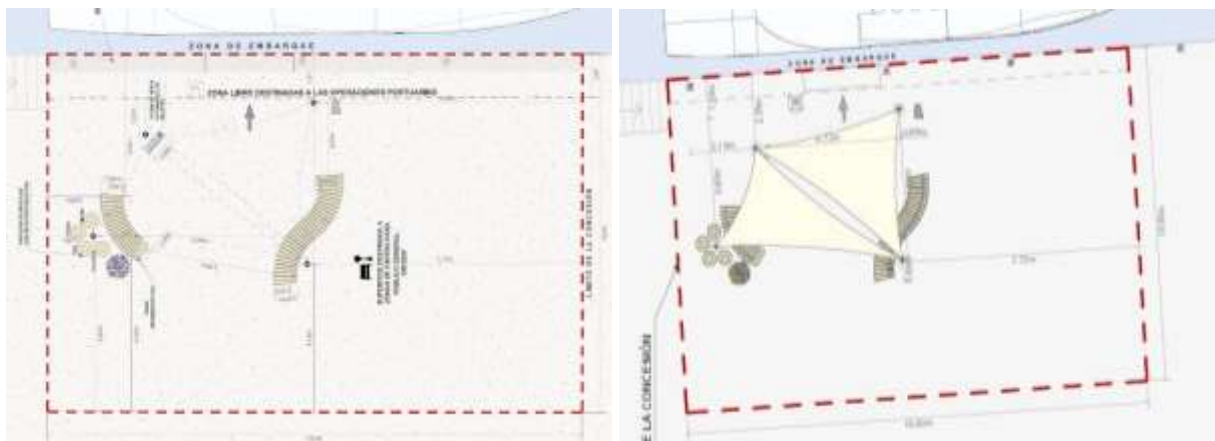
Faro de Portopí. Planta general y planta de cubiertas
